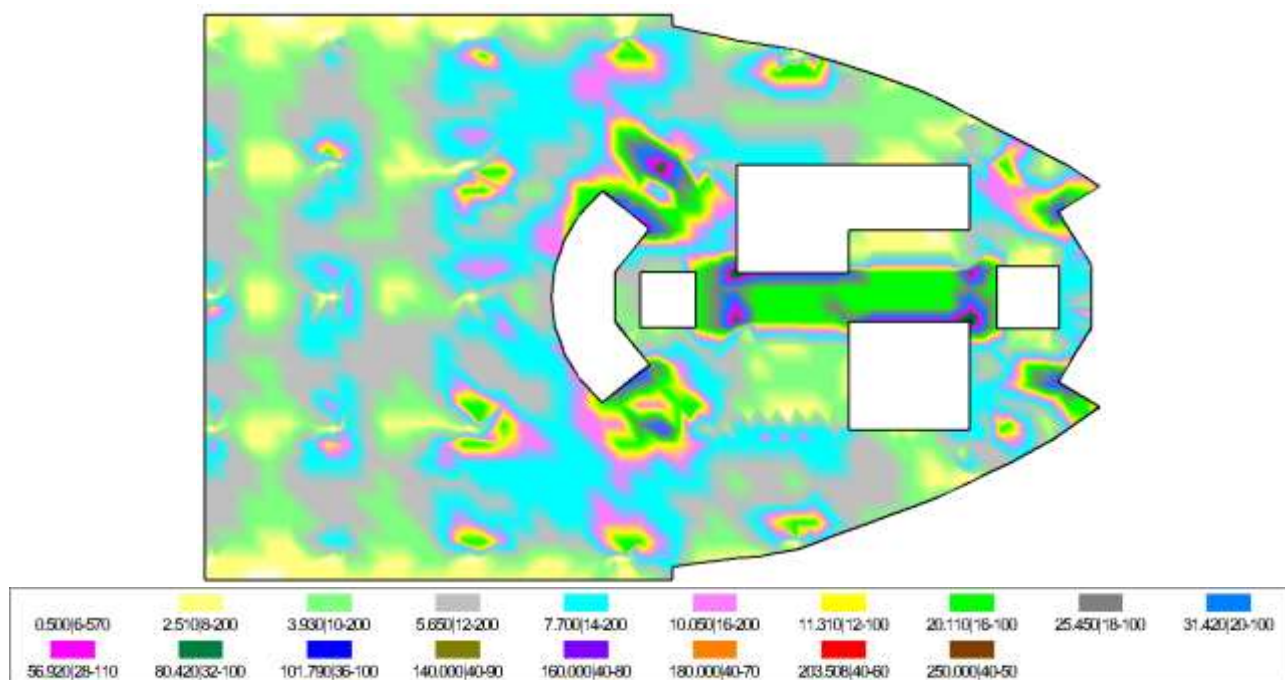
Армирование плиты перекрытия западной башни на отм. +42,80 м. Нижняя продольная арматура в направлении оси S, см²/м [15]
